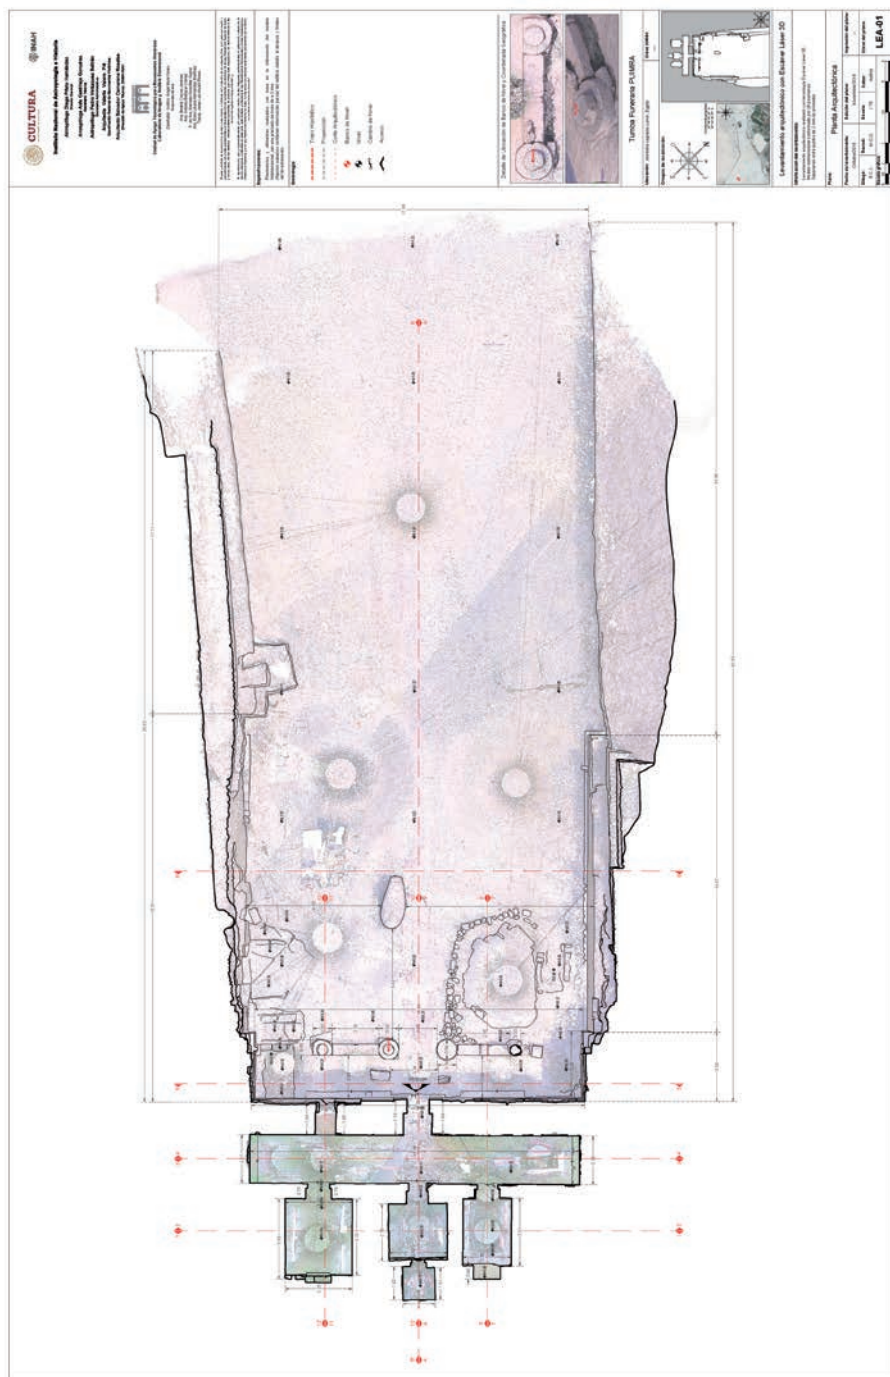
Planta arquitectónica con textura realista de pisos, realizada con escáner 3D Leica del Patio y de la fachada de la TT 39.
